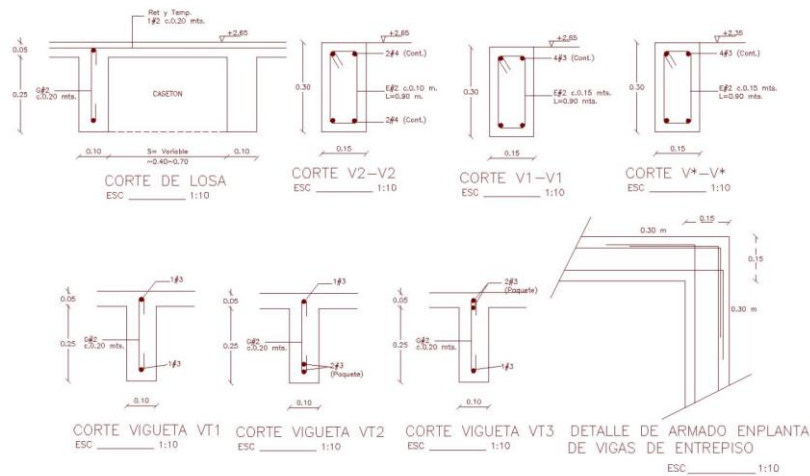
Figura No.14 Plano estructural detalles de losa de entrepiso
